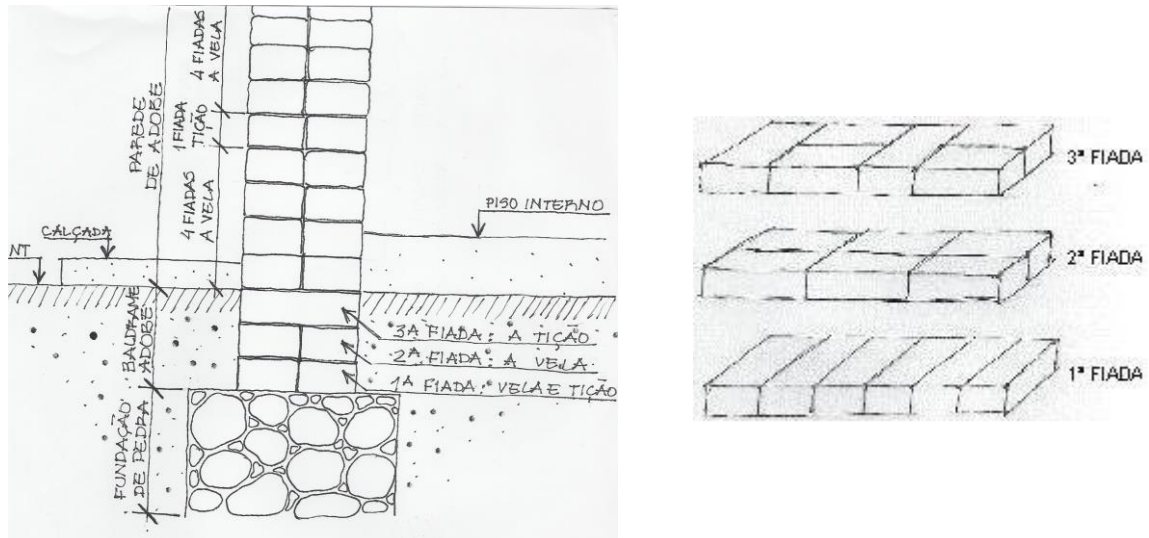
Esquema, em corte, da construção da fundação, baldrame e parede, com e detalhe da distribuição das 3 fiadas dos adobes no baldrame
